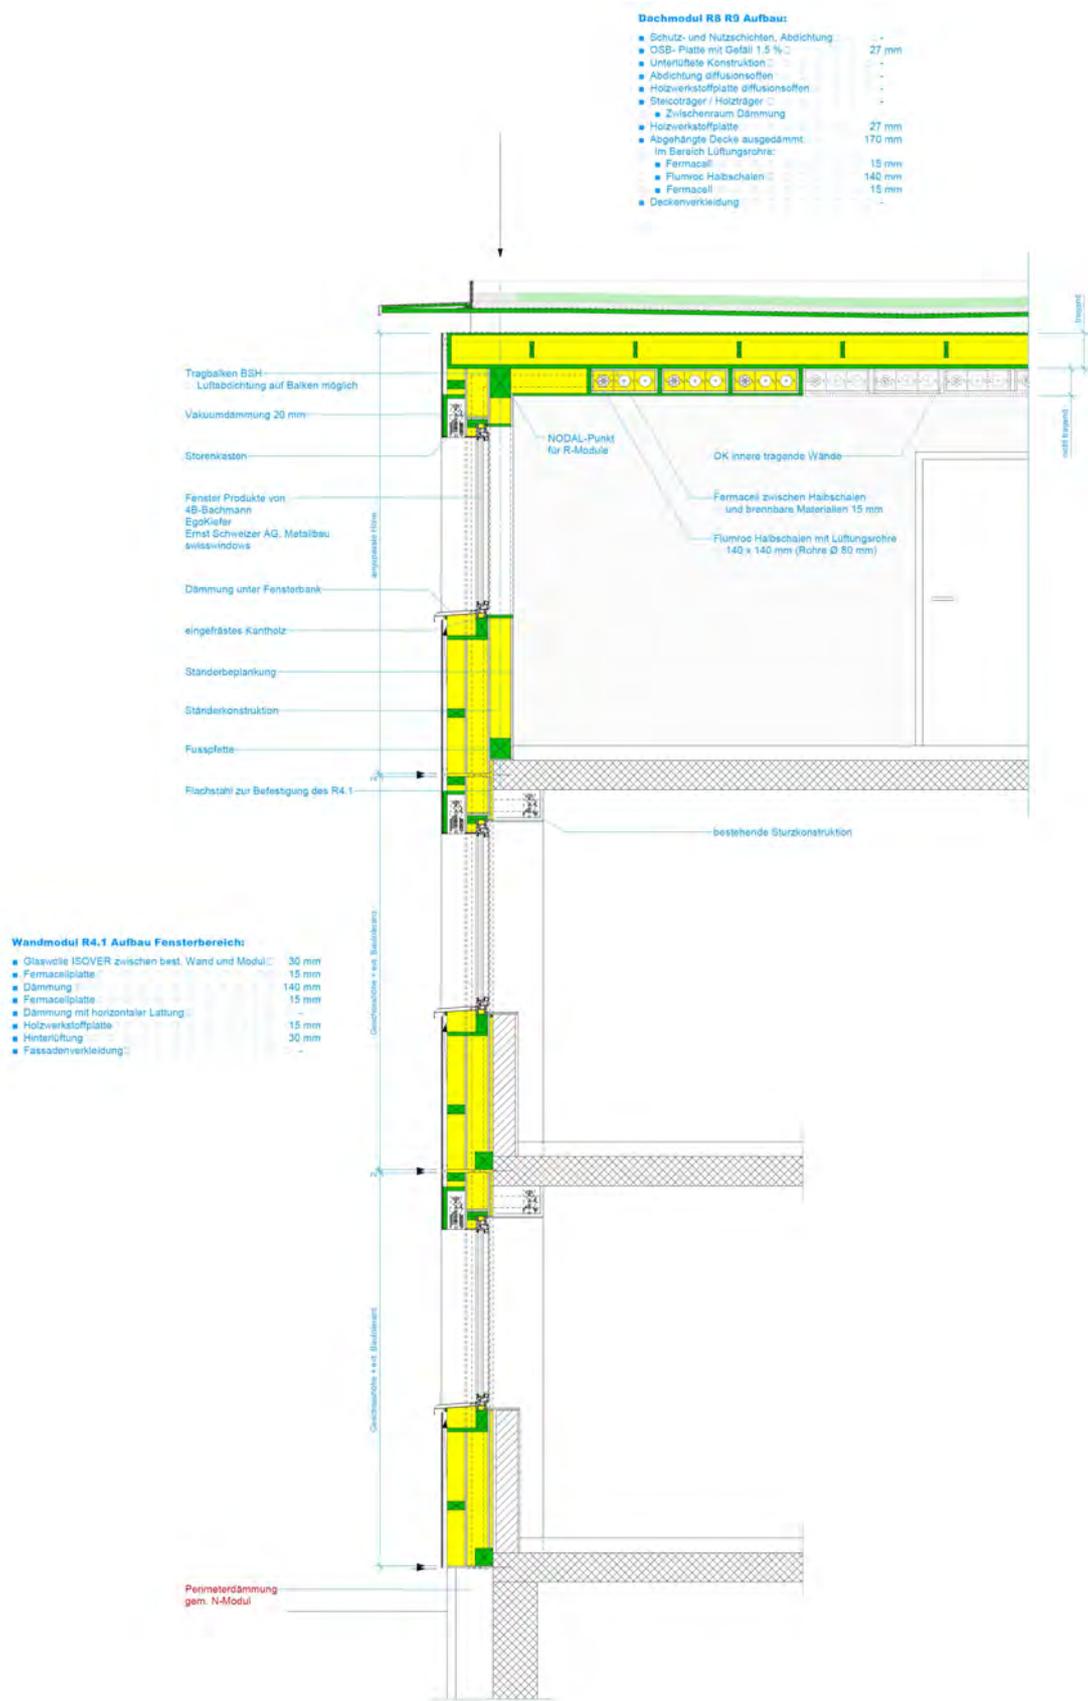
Schnitt eines bestehenden zwei-stöckigen Gebäudes, Fassaden mit Basismodul F4.1, Aufstockung mit leicht geänderten Basismodul F4.1 (R9) und vorgefertigtem Flachdach (R8) in Leichtbauweise
